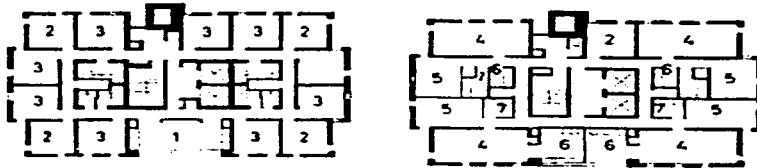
Arriba: Planta del Piso 13, Abajo: Planta General, 1.- Cocina campesino, 2.- Habitación estudio, 3.- Cuarto de trabajo, 4.- Estancia, 5.- Dormitorio, 6.- Cocina, 7.- Baño.
